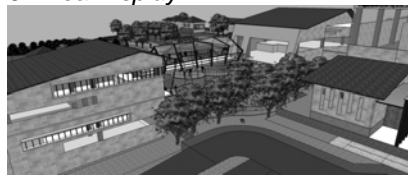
Area Latihan Anjing Dewasa pada *Layout Plan
